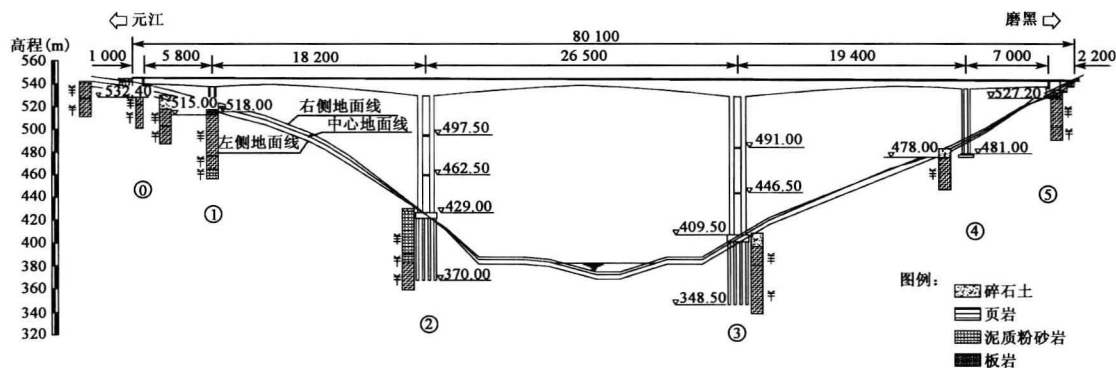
桥型总体布置图(尺寸单位:cm;高程单位:m)
